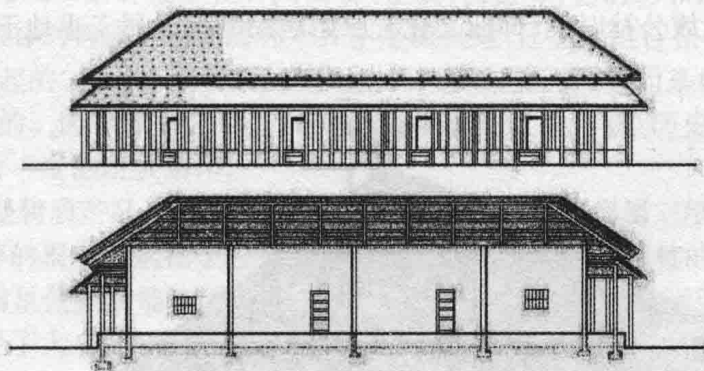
湖北盘龙城宫殿复原图(上为南立面图,下为剖面图)
